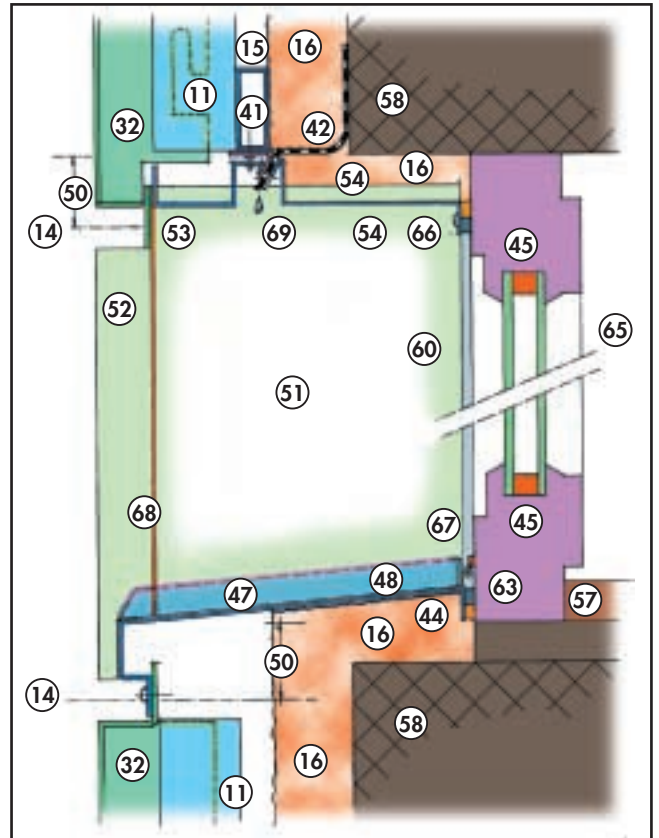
b) - Sezione verticale della finestra nel muro, allineata con le sole linee orizzontali
